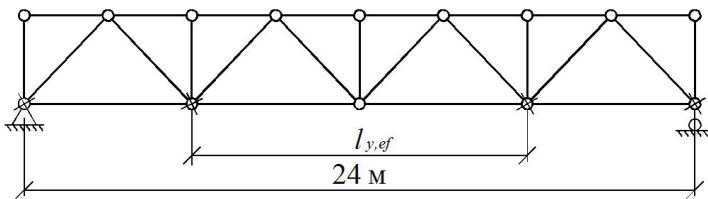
Схема расположения точек крепления связей по нижнему поясу фермы:
